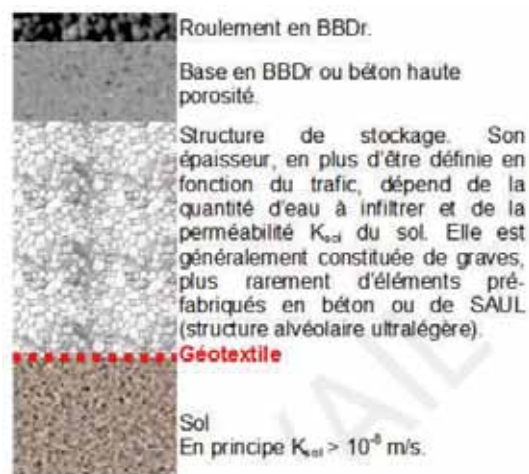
Exemple de structure de chaussée infiltrante avec couche de roulement en béton bitumineux drainant (BBDr)
